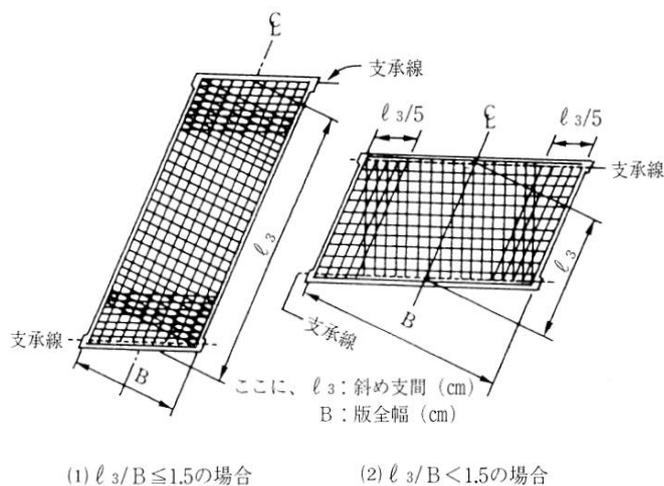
コンクリート主版を用いた斜橋の鉄筋配置
